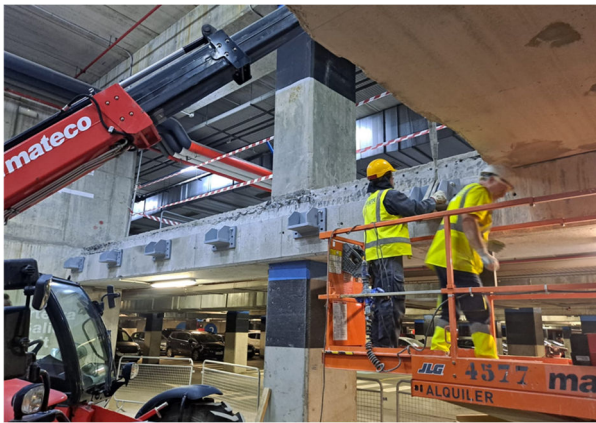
Detalle de instalación de puntos de apoyo de las vigas metálicas longitudinales
